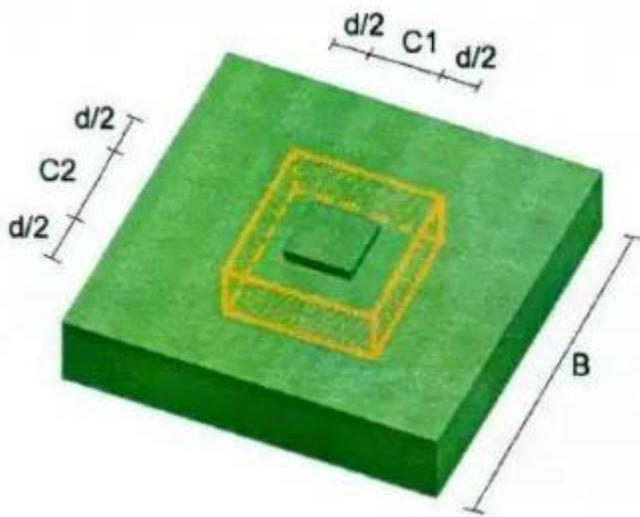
Sección crítica a cortante tipo punzonamiento
